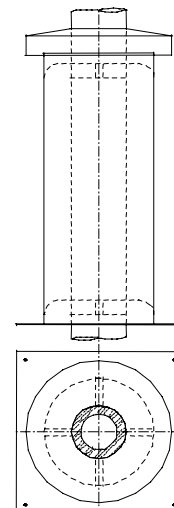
Aufbau Stulprohr mit integrierter Ablufführung
